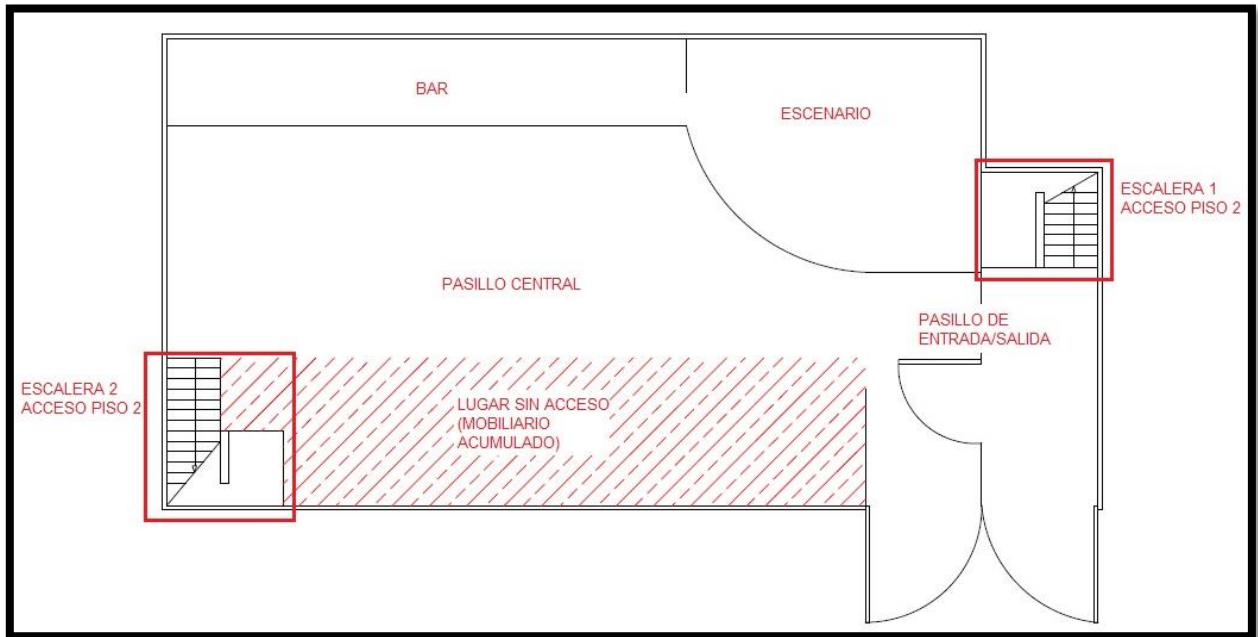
“Partes de la primera planta (cota +0.00) de la discoteca 2.”
